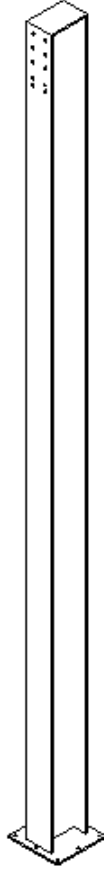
Pilar metàl·lic perfil HEB450 pels pilars exteriors. (Font: "Revit")
